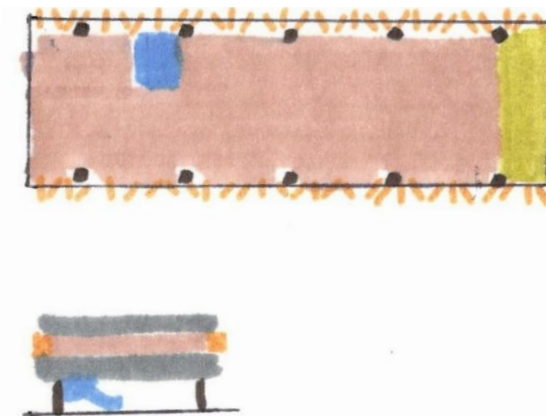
Plaenge. O projeto original contempla apenas um pavimento em planta livre elevado sobre pilotis, dialogando com o entorno.
